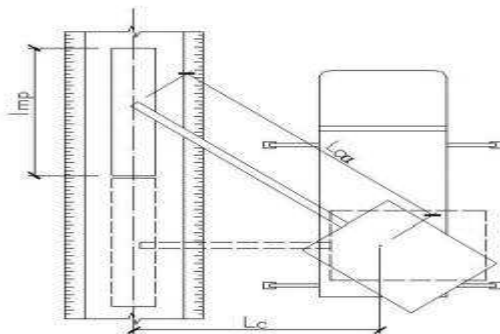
Схема монтажа трубы при повороте крана в плане
